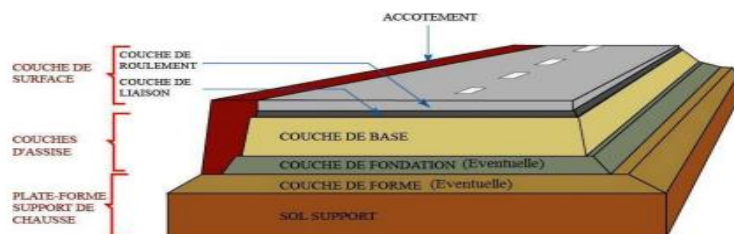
Structure type d'une chaussée revêtue (Source : SAWADOGO, 2015)
